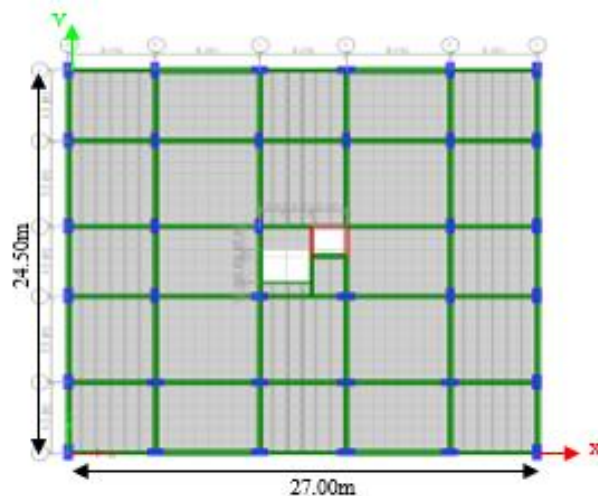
Planta de las edificaciones con sistema tradicional aporticado. ETABS 2016 [14]
